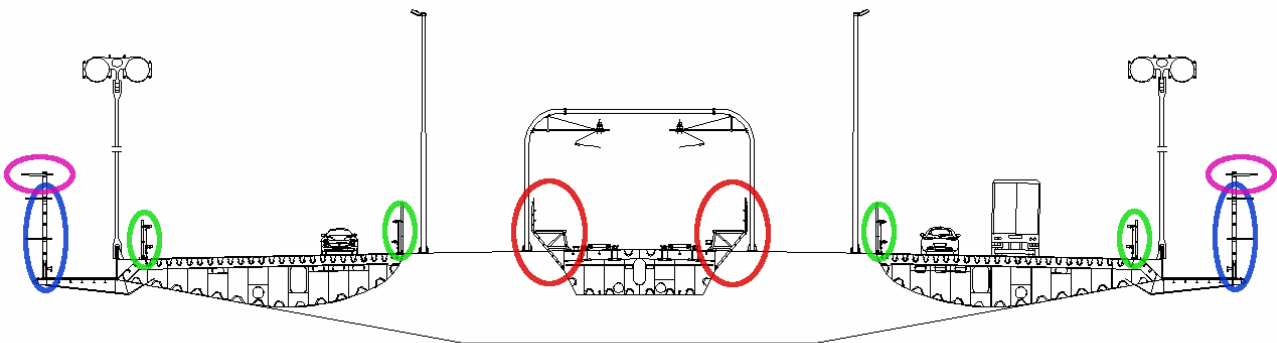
Elementi non lineari nella sezione dell'impalcato
